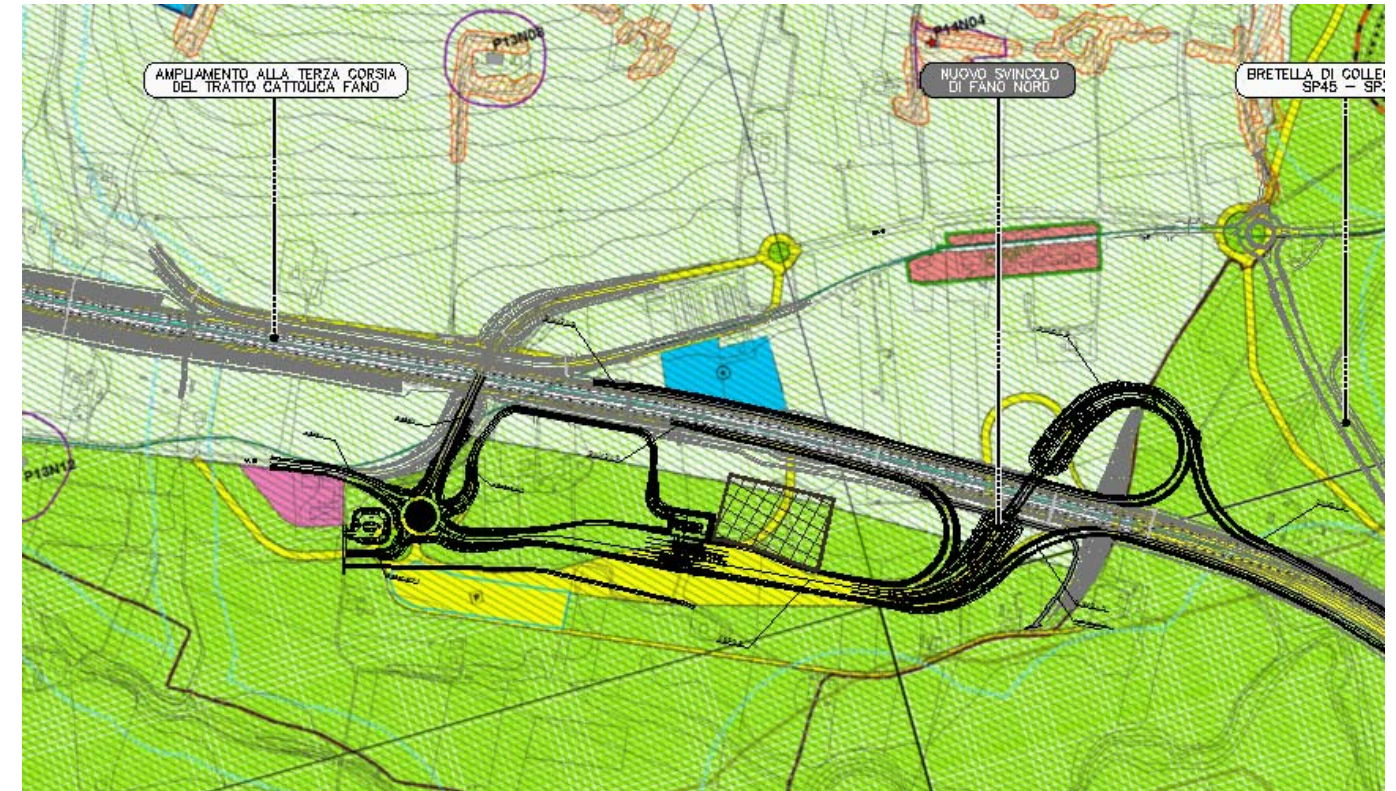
sovrapposizione planimetria MODIFICATA – PRG (MAM-QPRMA-009-1)
